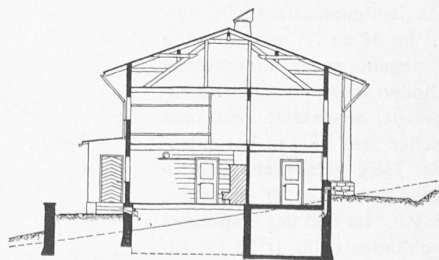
bis 6. Grundrisse und Schnitt. — 1:300.
